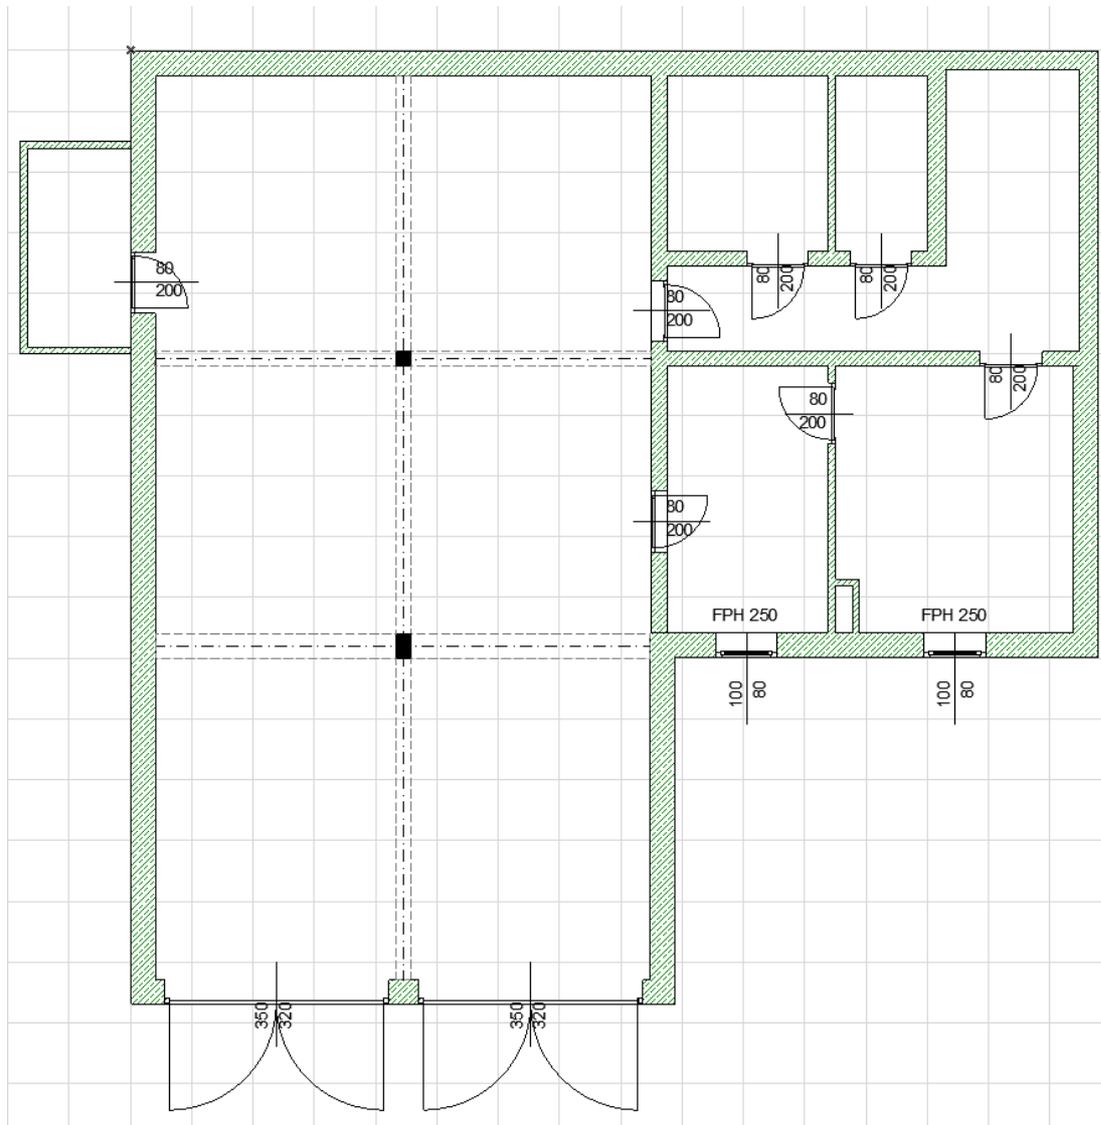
Grundriss Bestandsgebäude 1.Untergeschoss [50]
